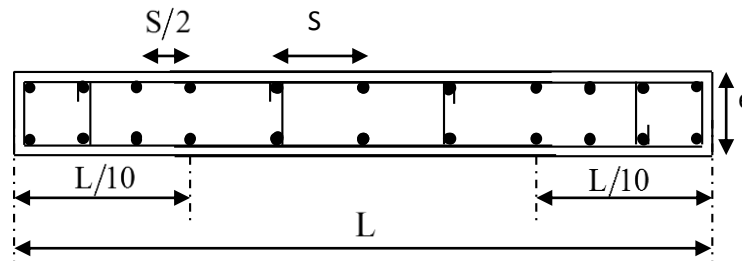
Disposition des armatures verticales dans les voiles.
